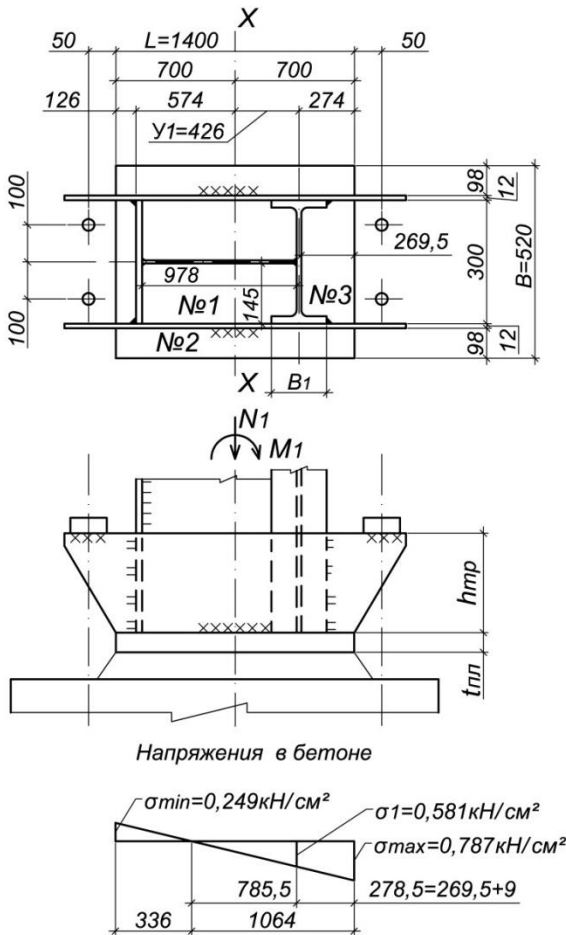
База колонны. Эпюра напряжений в бетоне под плитой. №1, №2, №3 – расчетные участки плиты
